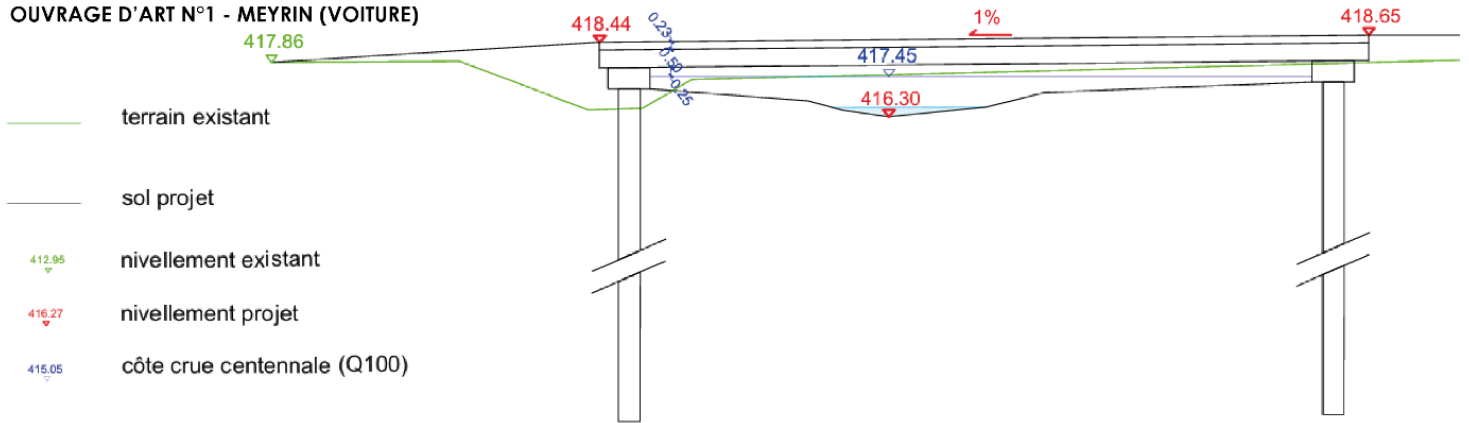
Coupe des ouvrages de franchissement sur la rue de Meyrin, Bordas+Peiro, avril 2024
